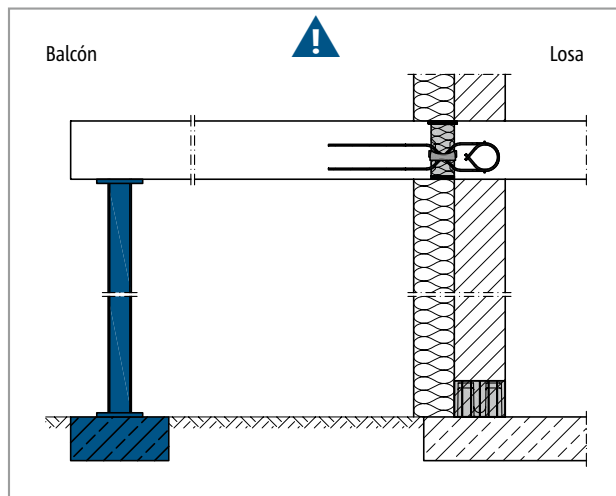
Schöck Isokorb® T tipo Q-VV: Se requiere apuntalamiento continuo
